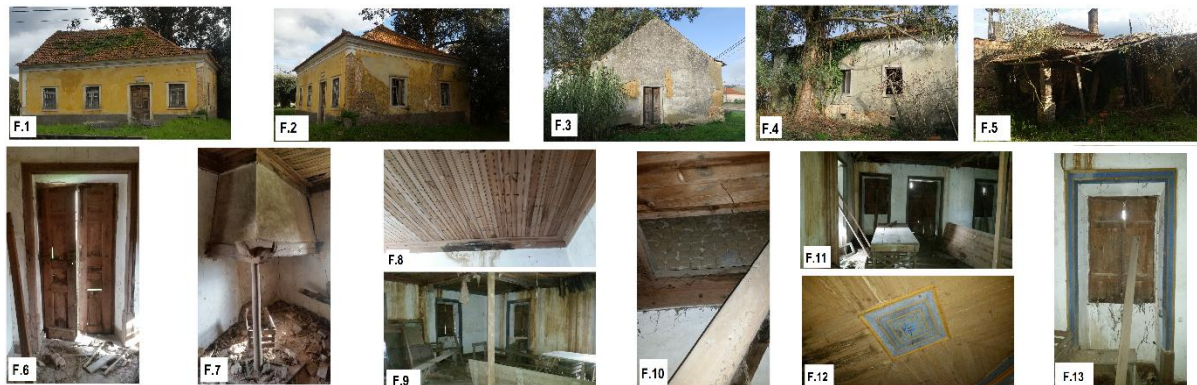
F.1 – Fachada Norte; F.2 – Fachada Oeste; F.3 – Fachada Este; F.4 – Fachada Sul; F.5 – Anexo em adobe; F.6 – Porta exterior em madeira (Fachada Este); F.7 – Chaminé da cozinha; F.8 – Forro em madeira; F.9 – Vista da sala para os quartos; F.10 – Escada de acesso ao sótão; F.11 – Porta exterior em madeira (Fachada Norte); F.12 – Acabamentos decorativos dos tetos dos quartos e sala; F.13 – Janela com portadas em madeira e moldura decorativa
